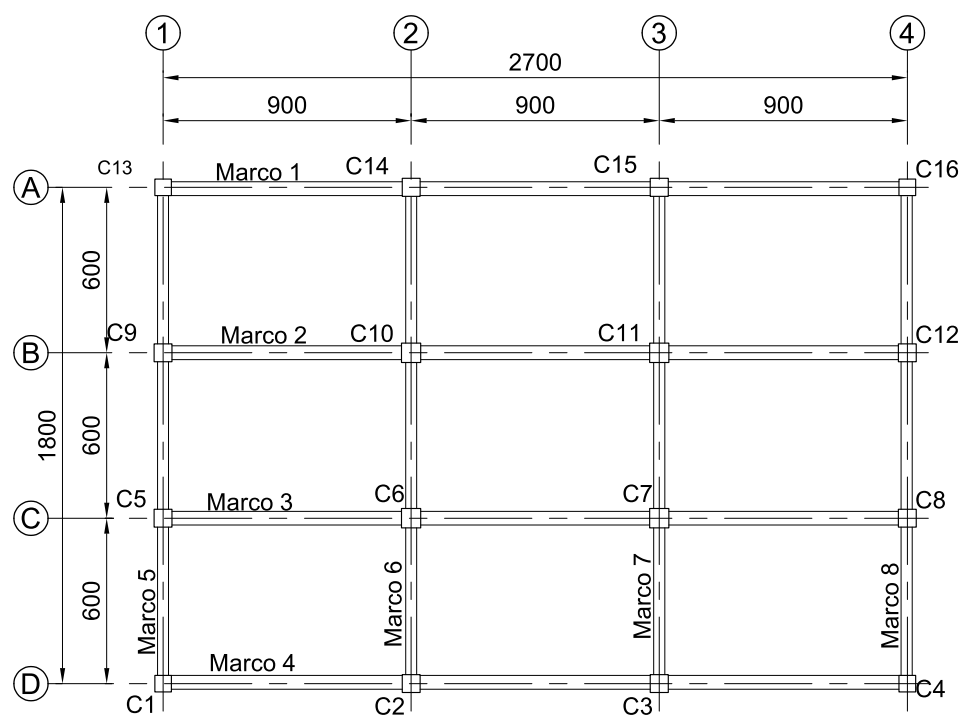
Plantas de N2-N5 y azotea: Muestra marcas de vigas (marcos) y columnas
